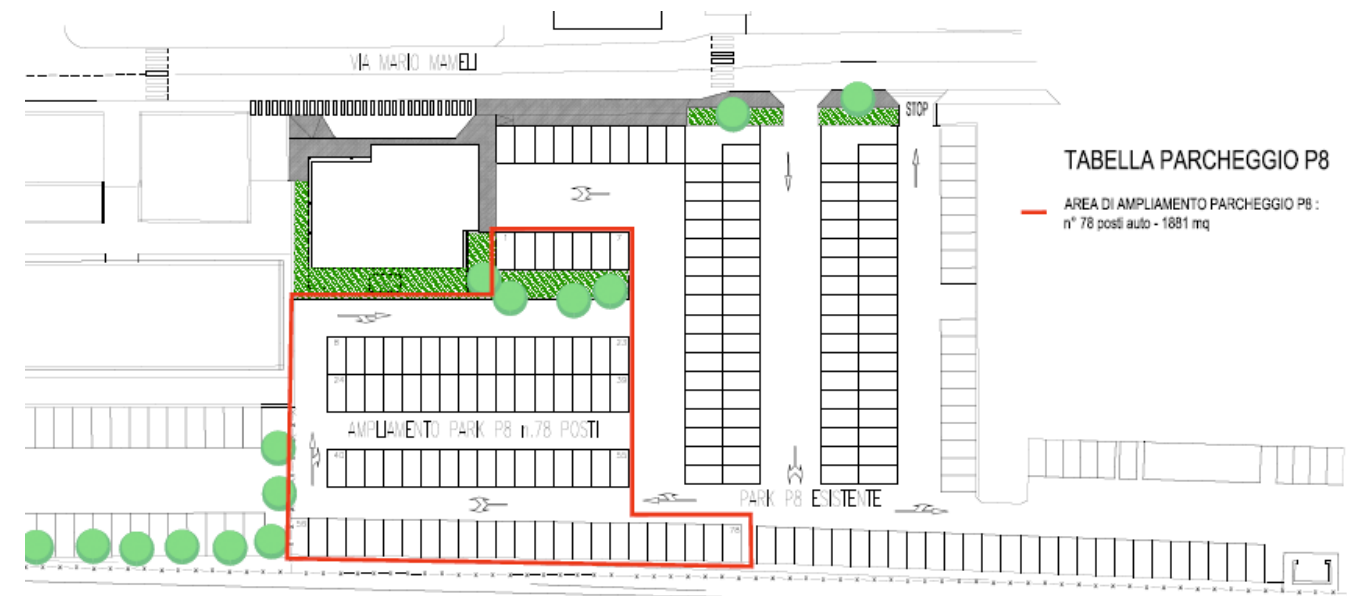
PARCHEGGIO A RASO COPERTO CON STRUTTURA FOTOVOLTAICA P8: PLANIMETRIA
